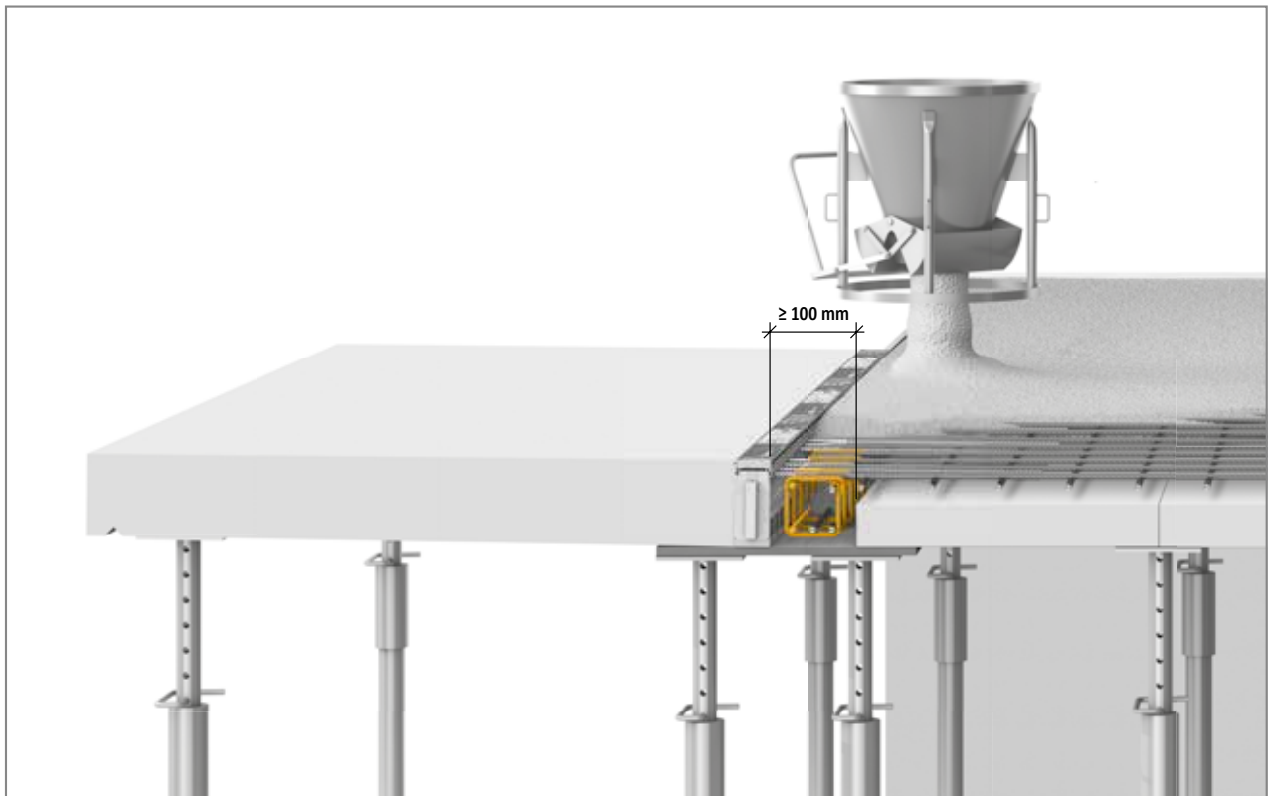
Schöck Isokorb® tipo K, riempimento della zona massiccia di aderenza con calcestruzzo in opera (giunto di compressione)
